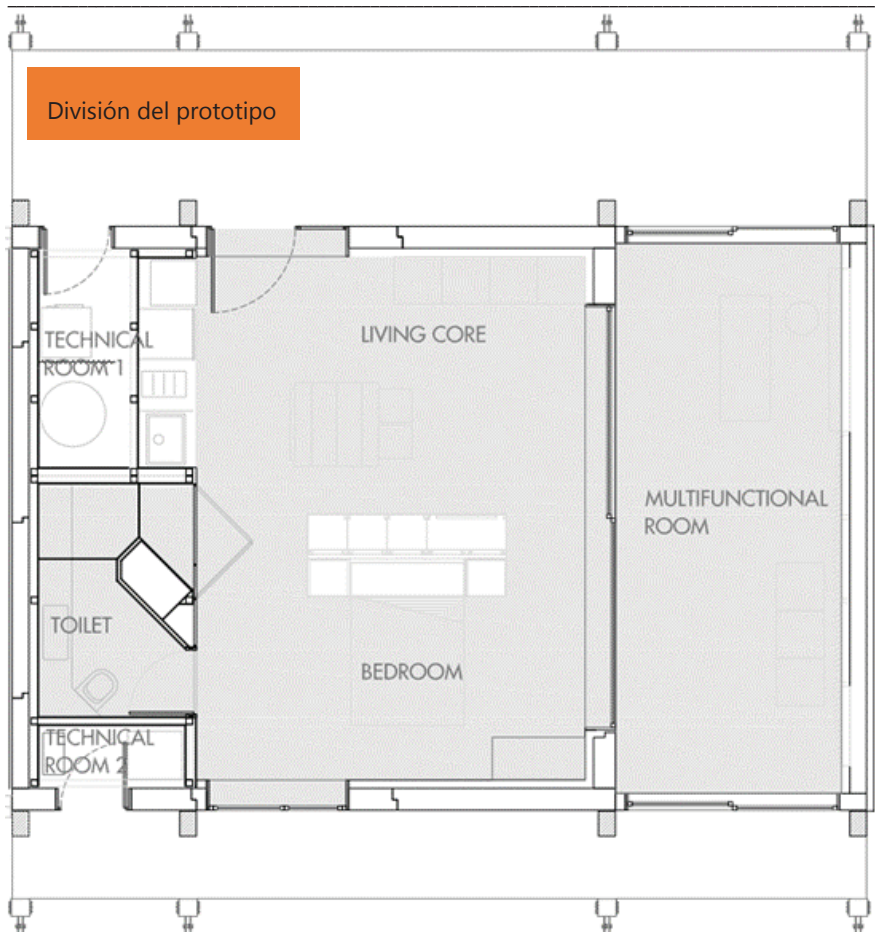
Planta de una de las viviendas prototipo con 10 m de fachada, donde se identifican los distintos espacios (Fuente Plateau Team)
